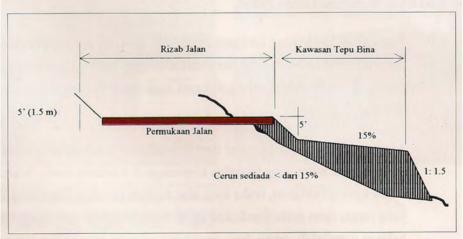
KERJA-KERJA TANAH BAGI JALAN DAN BANGUNAN
